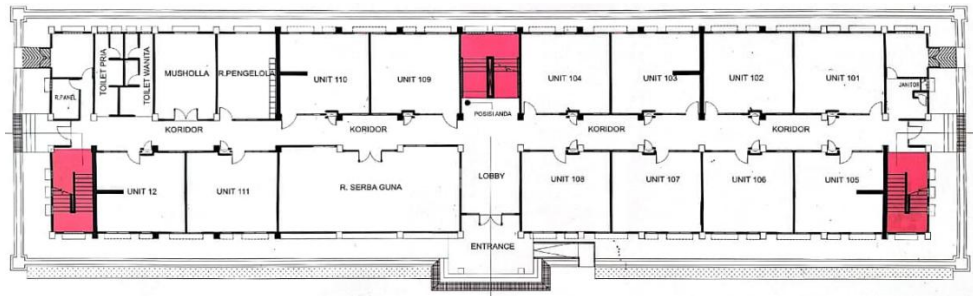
17 Fasilitas dalam rusunawa Semarang Hebat
